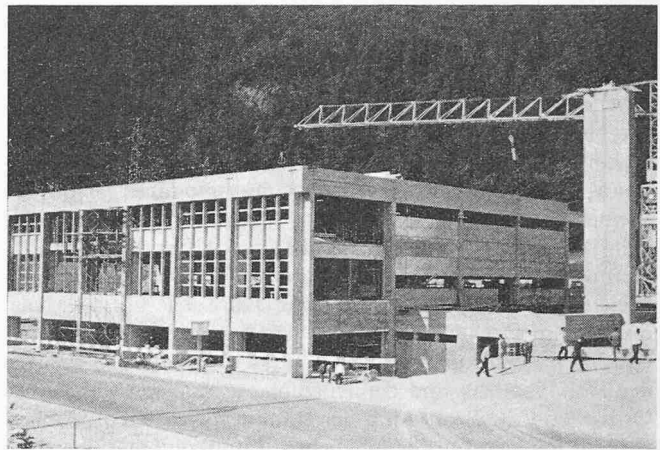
Neubau Mineralquelle Rhäzüns GR. Vollständig vorfabrizierte Produktionsanlage; Stützen, Unterzüge, Decken und Fassadenplatten
